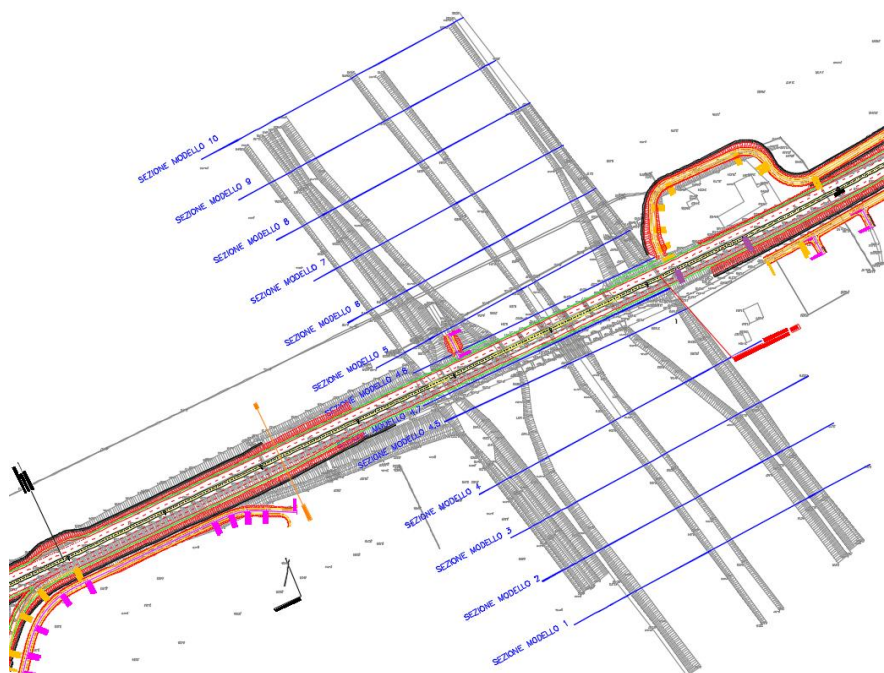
posizione planimetrica delle sezioni utilizzate nell'implementazione del modello idraulico (ante operam)
